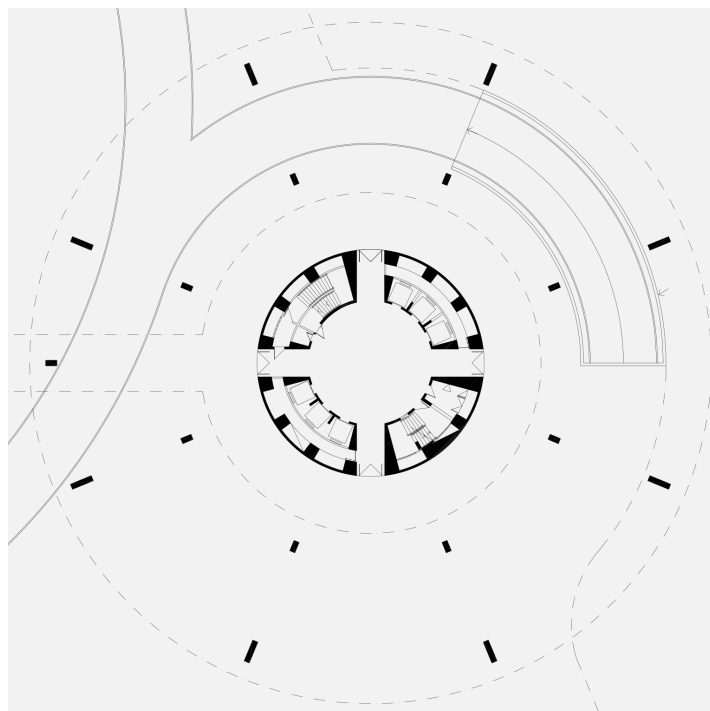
Planta do térreo, bloco B; Fonte: Arquivo da PGR
